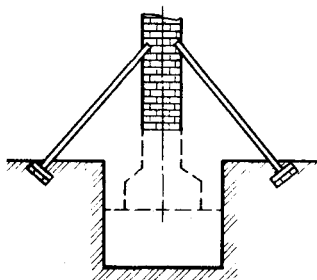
Перенос отметки заложения подошвы фундамента под колонну
